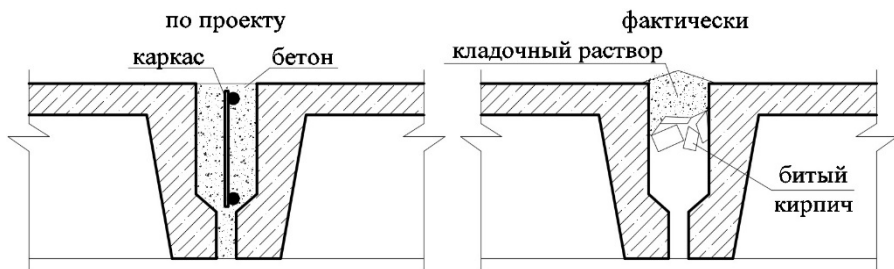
Исполнение швов между плитами покрытия с нарушениями проекта
